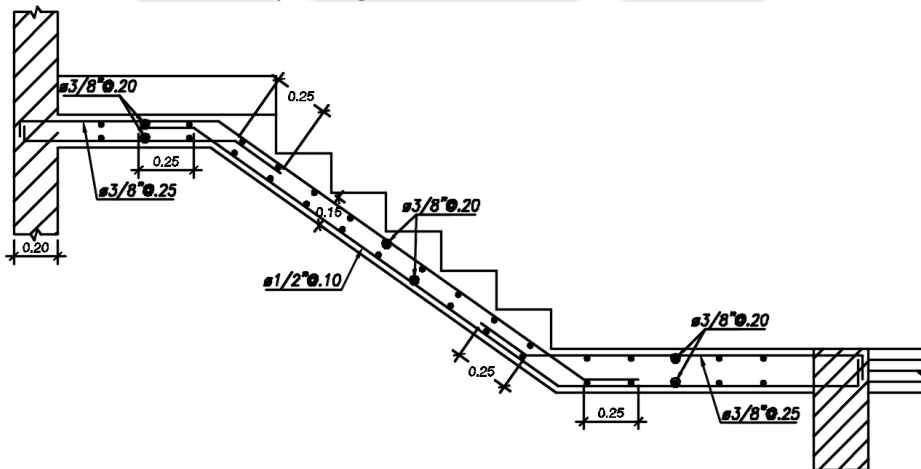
Refuerzo de acero en tramo más largo de escalera
